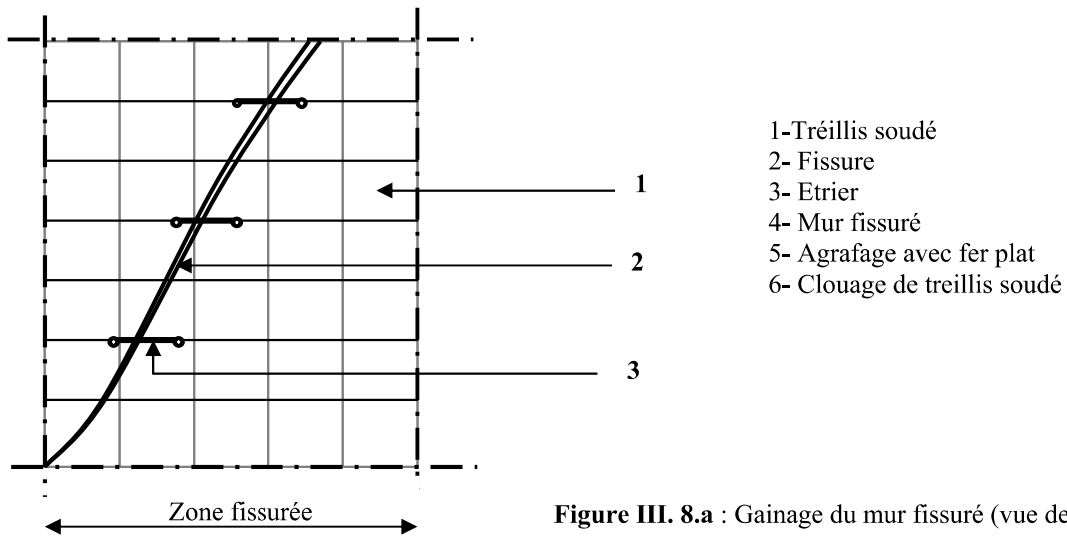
a : Gainage du mur fissuré (vue de face).
